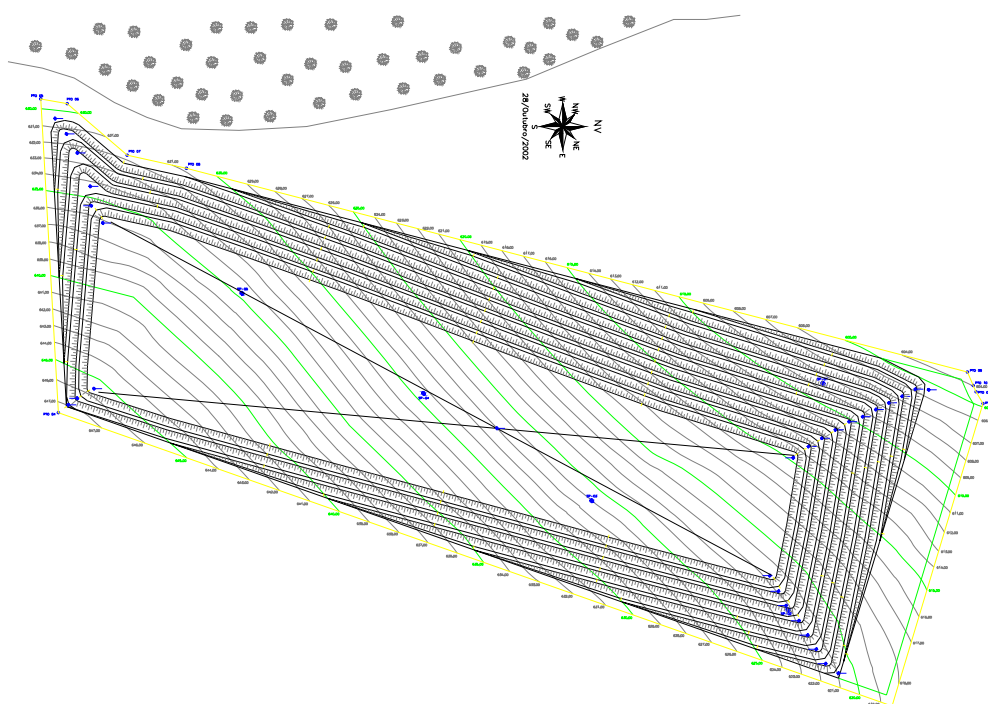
Aterro Sanitário de Americana - Planta de Situação
